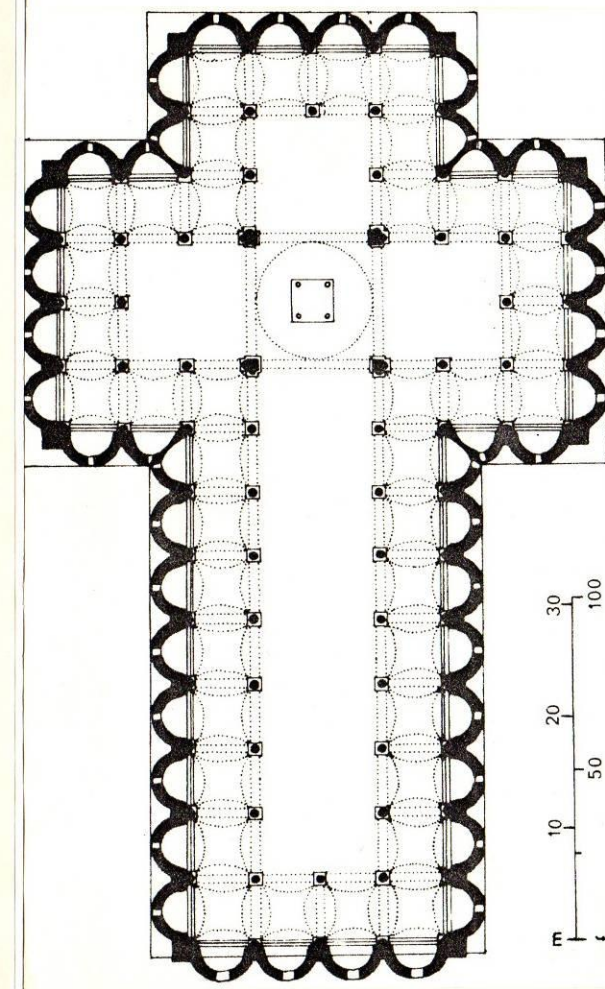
/111: San Spirito, Florence. Plan du projet original de 1436. D'après () FANELLI
